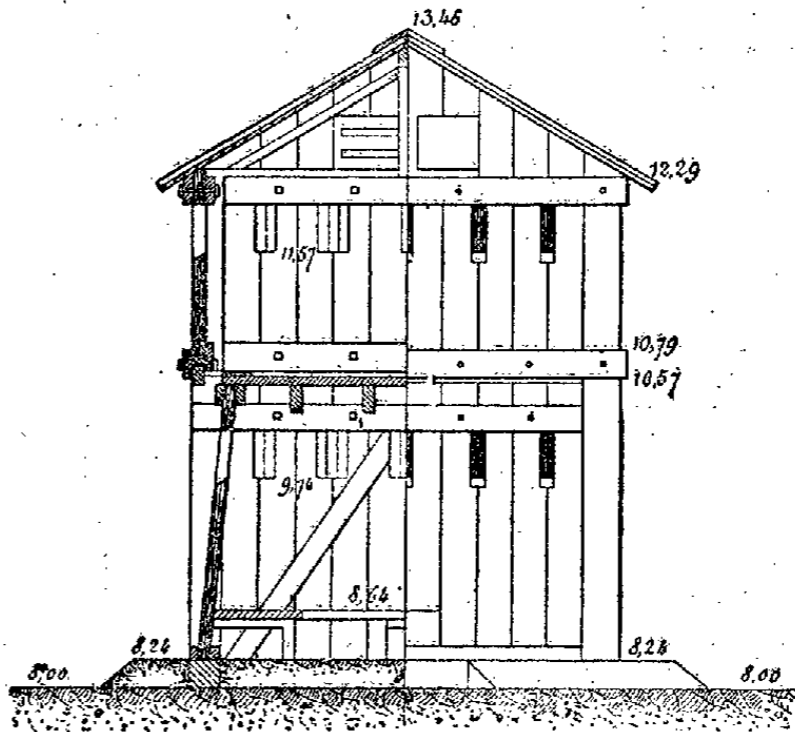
Coupe et élévation d'un blockhaus à étage.
